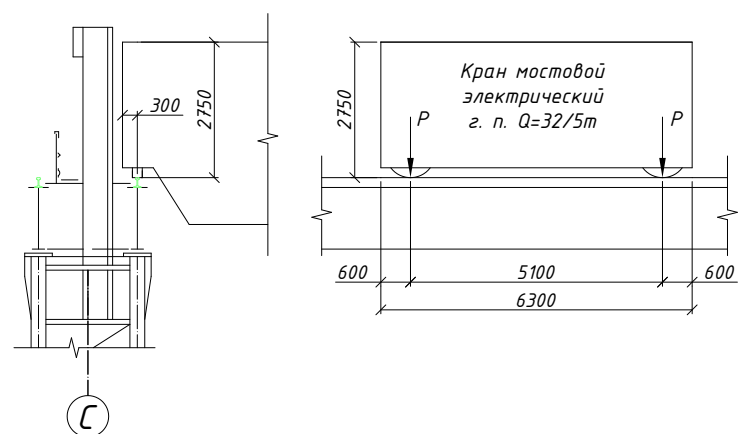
Схема опирания крана пролёта холодильника на рельсовый путь
